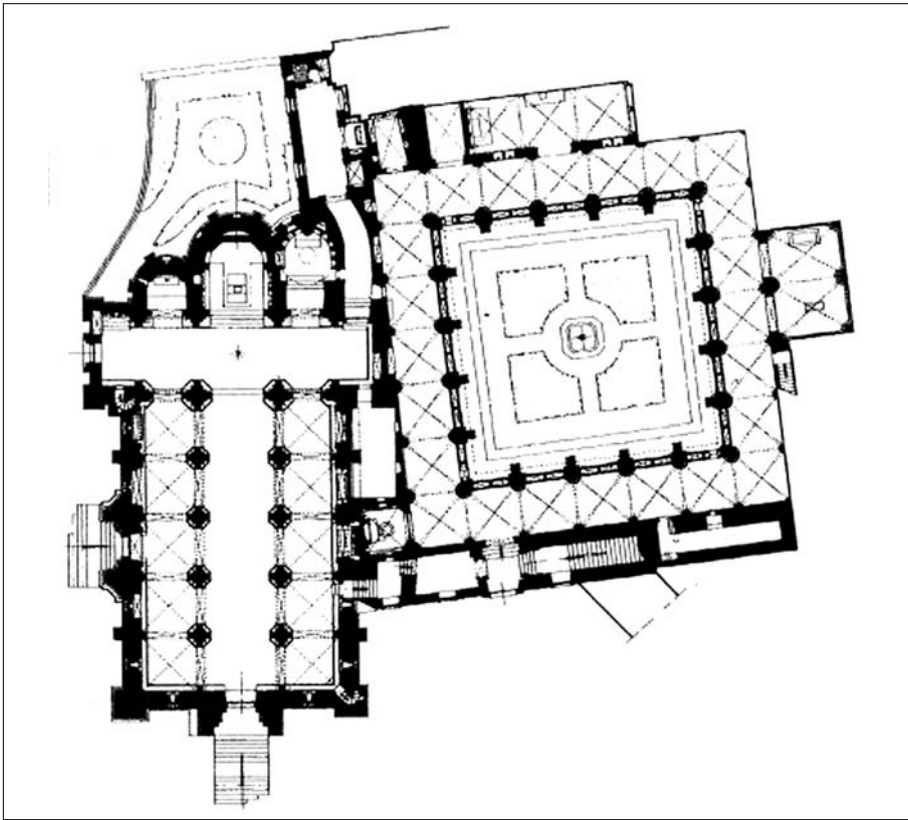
Catedral de Coimbra. Planta general (D.G.E.M.N.).
